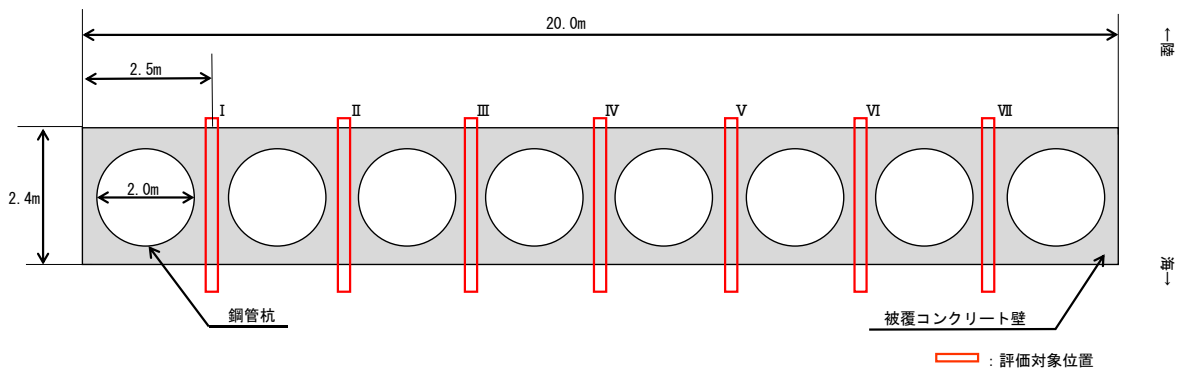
(1) 評価対象位置図 (③-③断面, 平面図)
